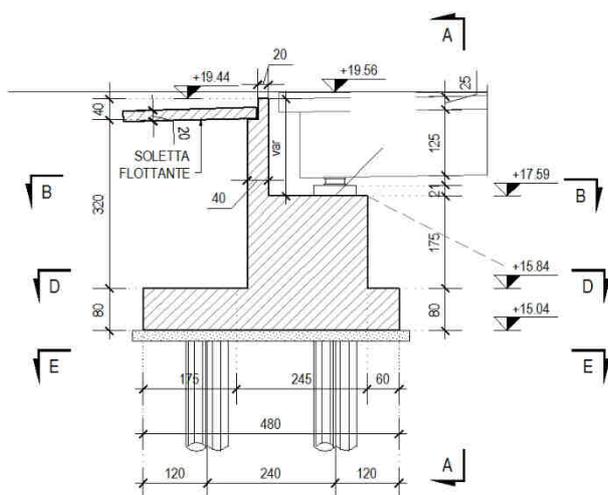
Spalla A sezione trasversale - Ponte Rio Salius su viabilità AV04
